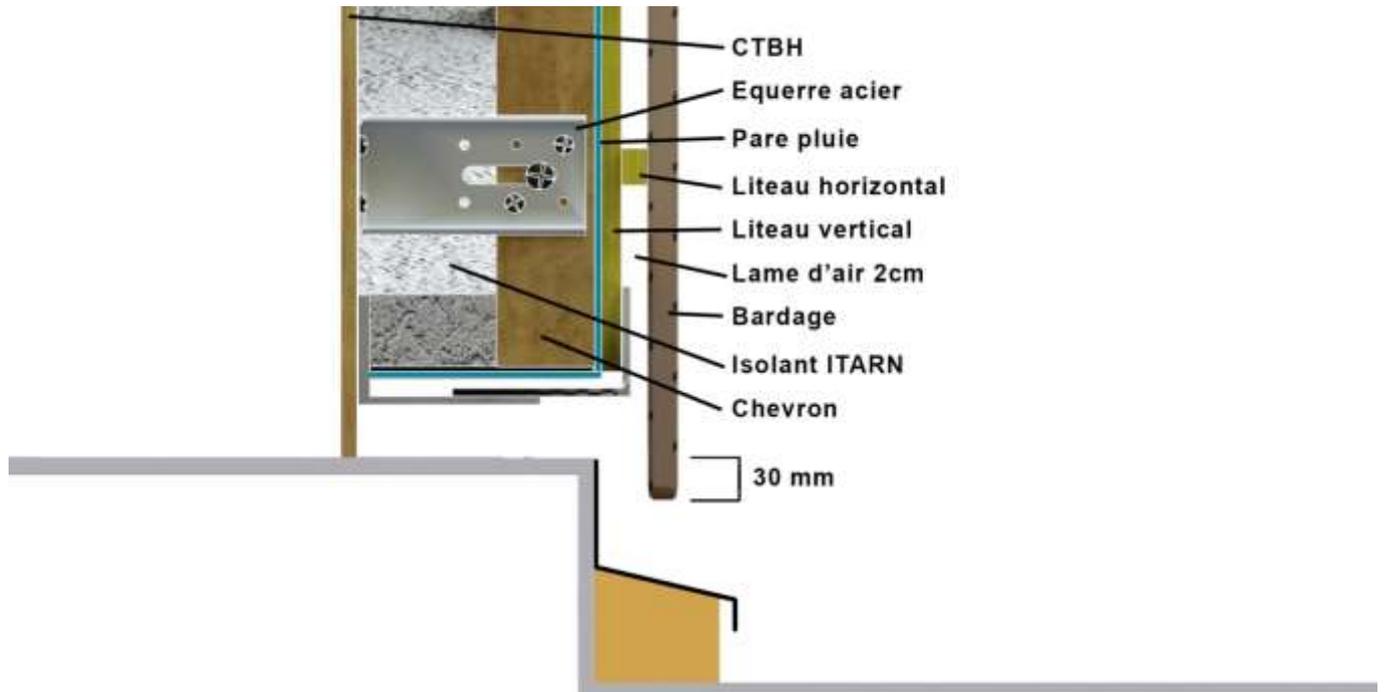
exemple traitement du pied de mur dans le cas de COB
